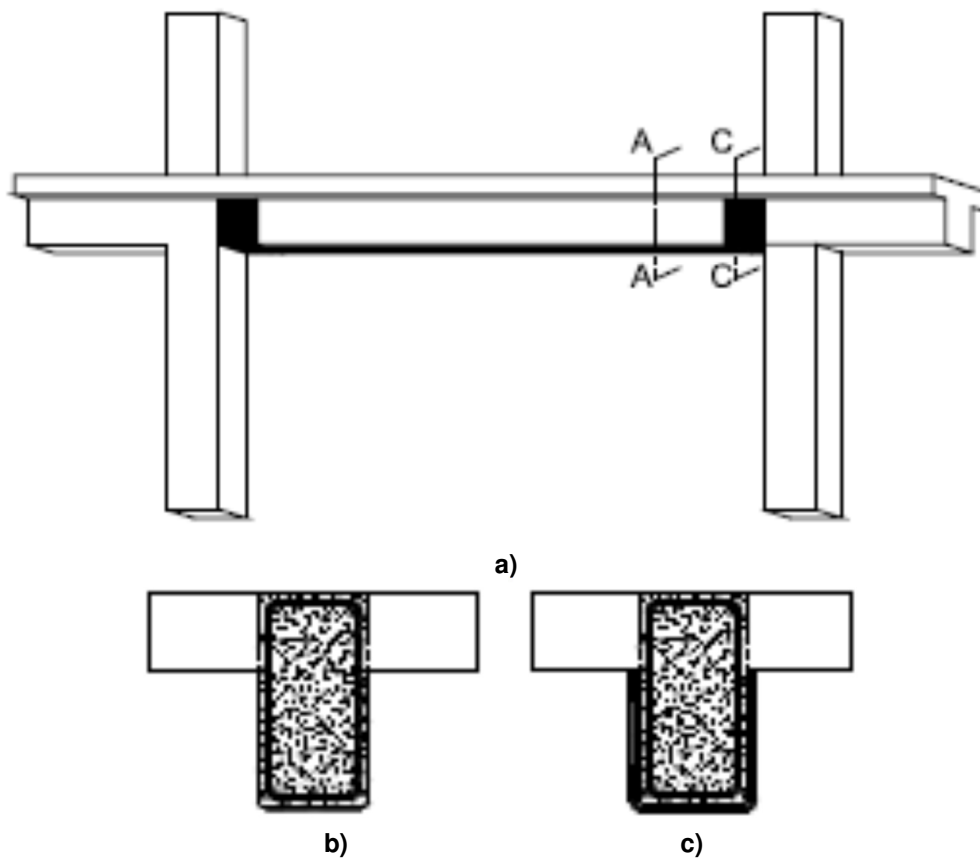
Reforzamiento a flexión con materiales compuestos CFRP o SRP de una viga de hormigón armado con anclaje en los extremos: a) Sección longitudinal; b) sección A-A; c) Sección C-C.
